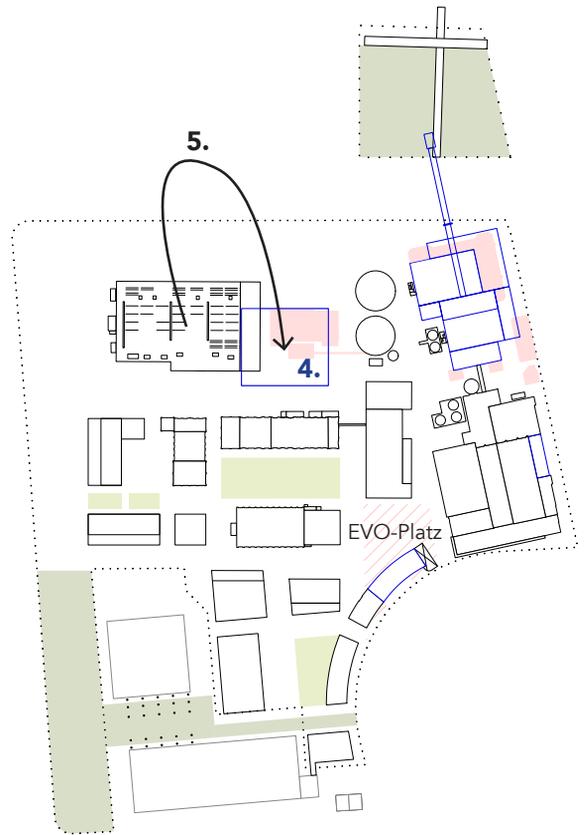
Detaillierter Strukturplan, M 1:2000. Quelle: Johanna Moraweg
